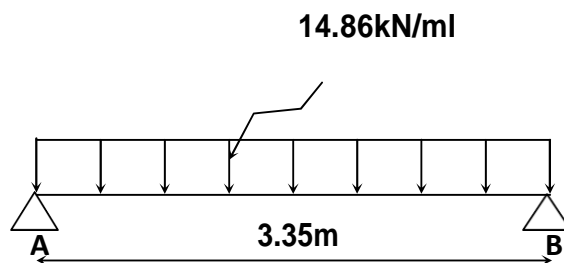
Schéma statique de la poutre de chaînage à l'ELU
